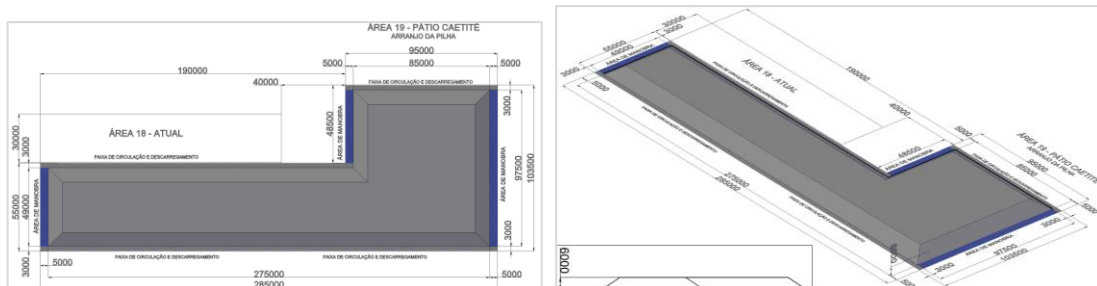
CONSTRUÇÃO DO PÁTIO.
